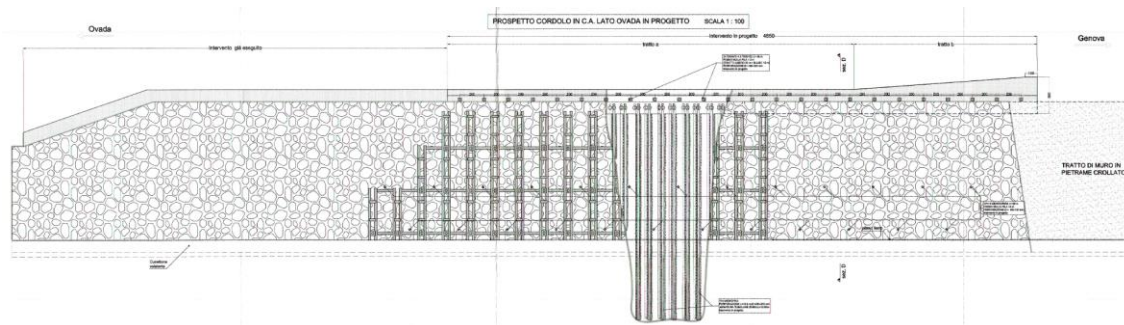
Stralcio degli interventi realizzati di consolidamento del muro in muratura lato Ovada.
